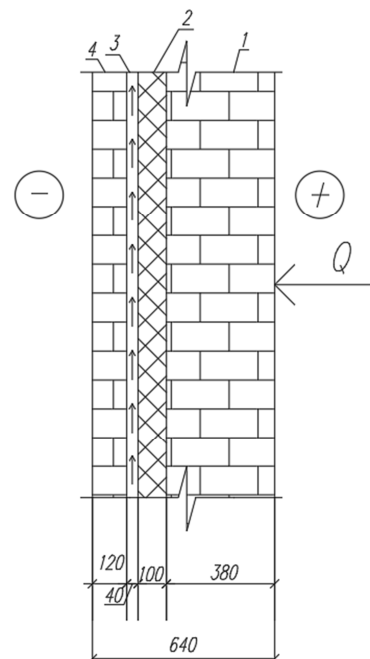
Конструкция стены: 1 – внутренняя верста, 2 – утеплитель, 3 – вентилируемая воздушная прослойка, 4 – наружная верста
